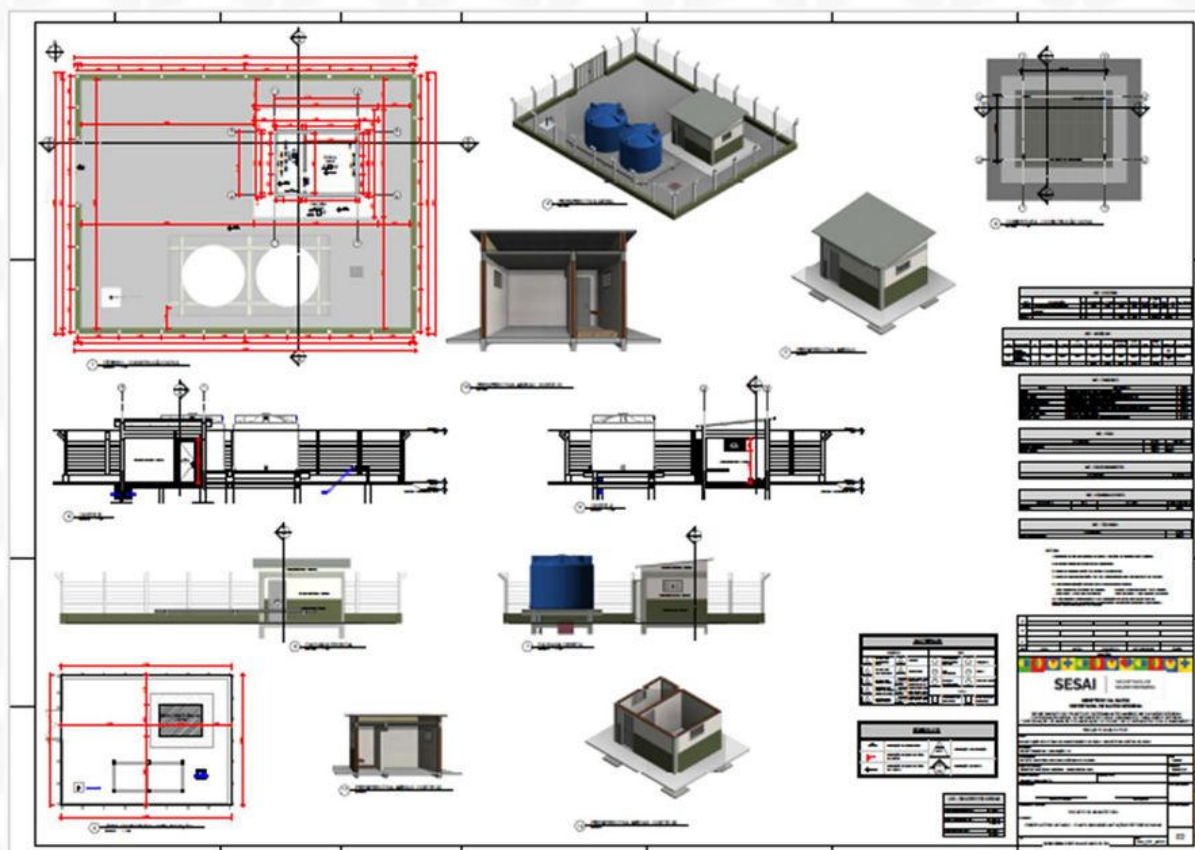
PLANTA RESERVATÓRIO ELEVADO
